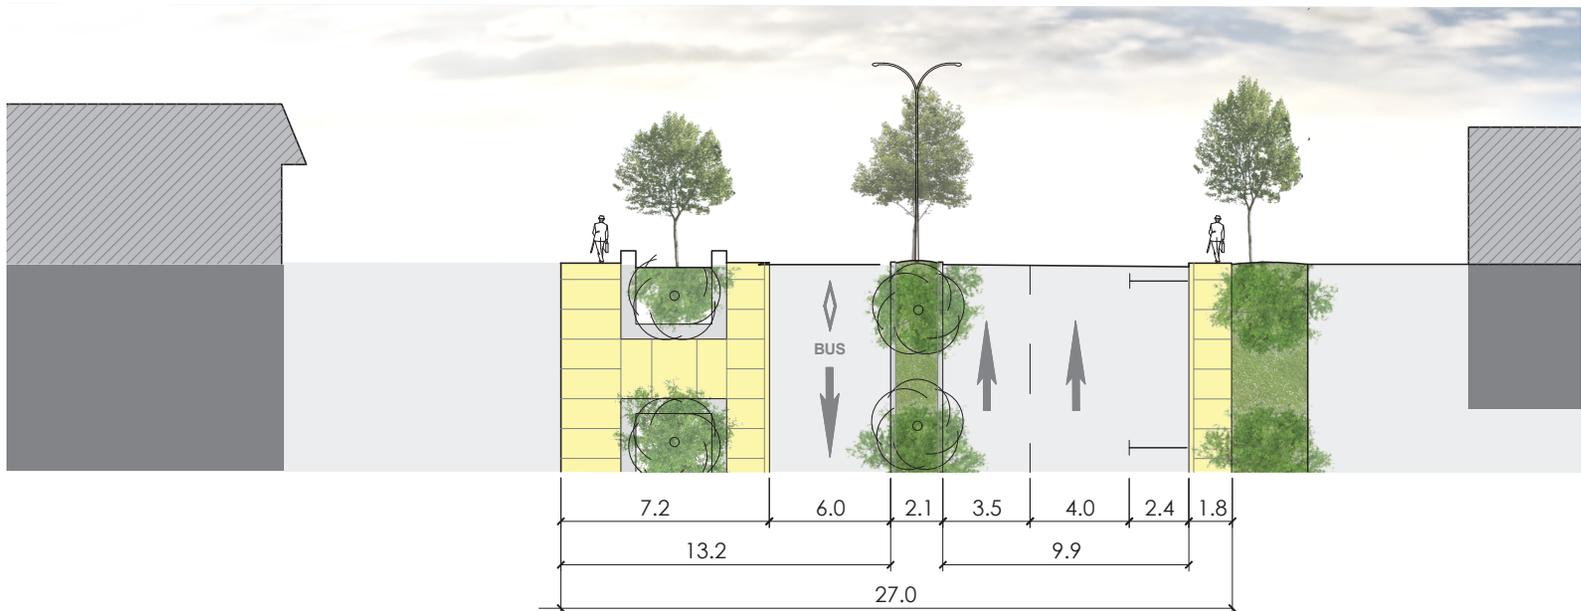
Coupe A2-A2', Proposition - boulevard St-Laurent entre Rue Jean-Talon et Rue de Castelnau O, échelle 1:300
